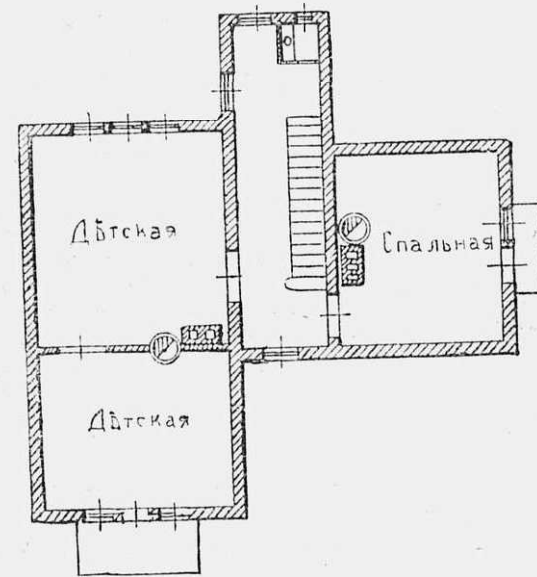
Планъ 2-го этажа дома въ усадьбѣ на 98 кв. саженьяхъ.
